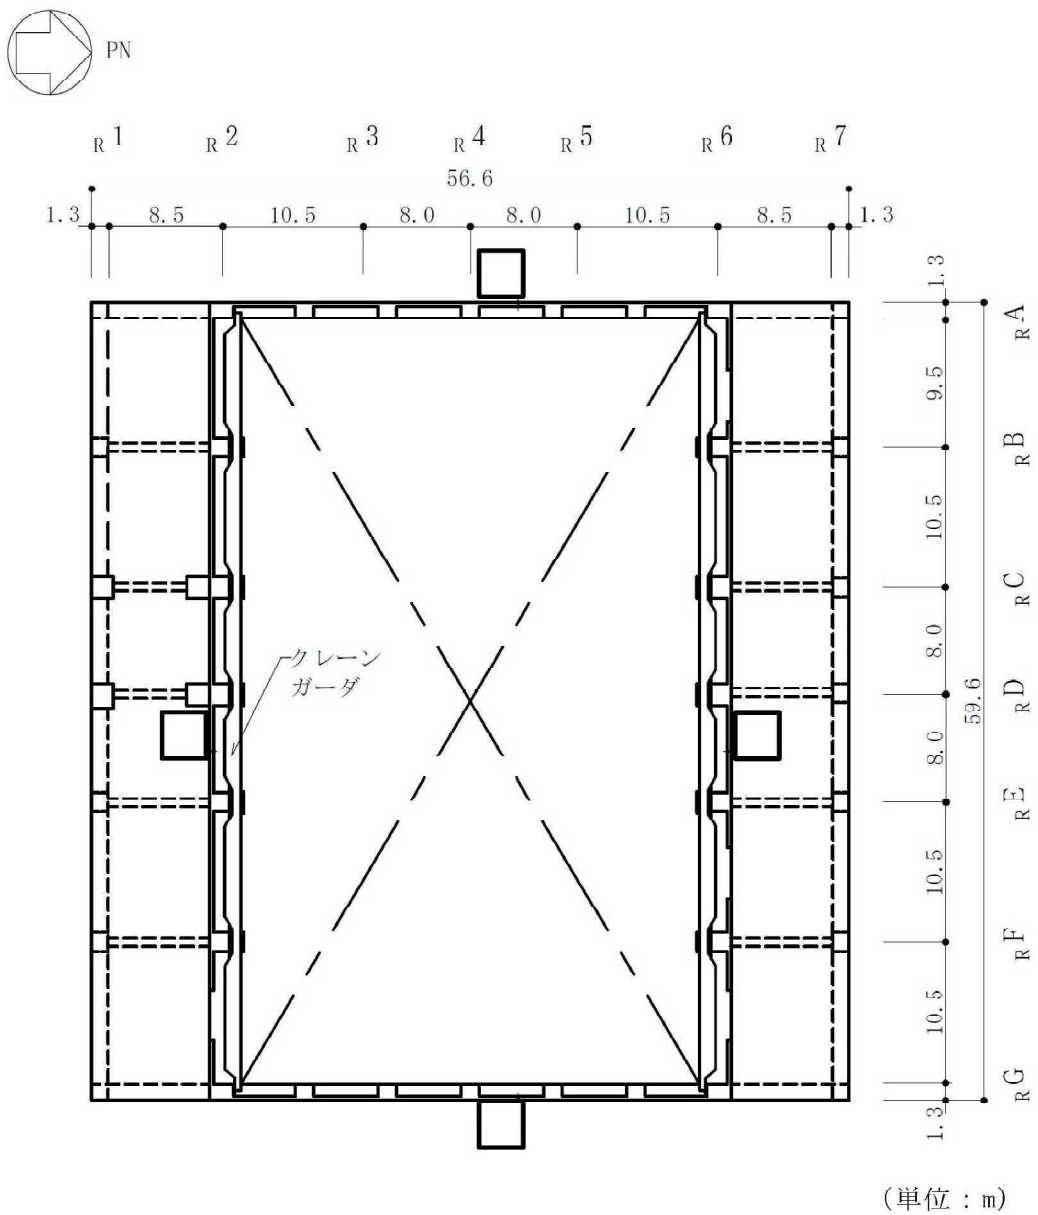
原子炉建屋の概略平面図 (CRF, T.M.S.L. 38.2m) (8/9)
